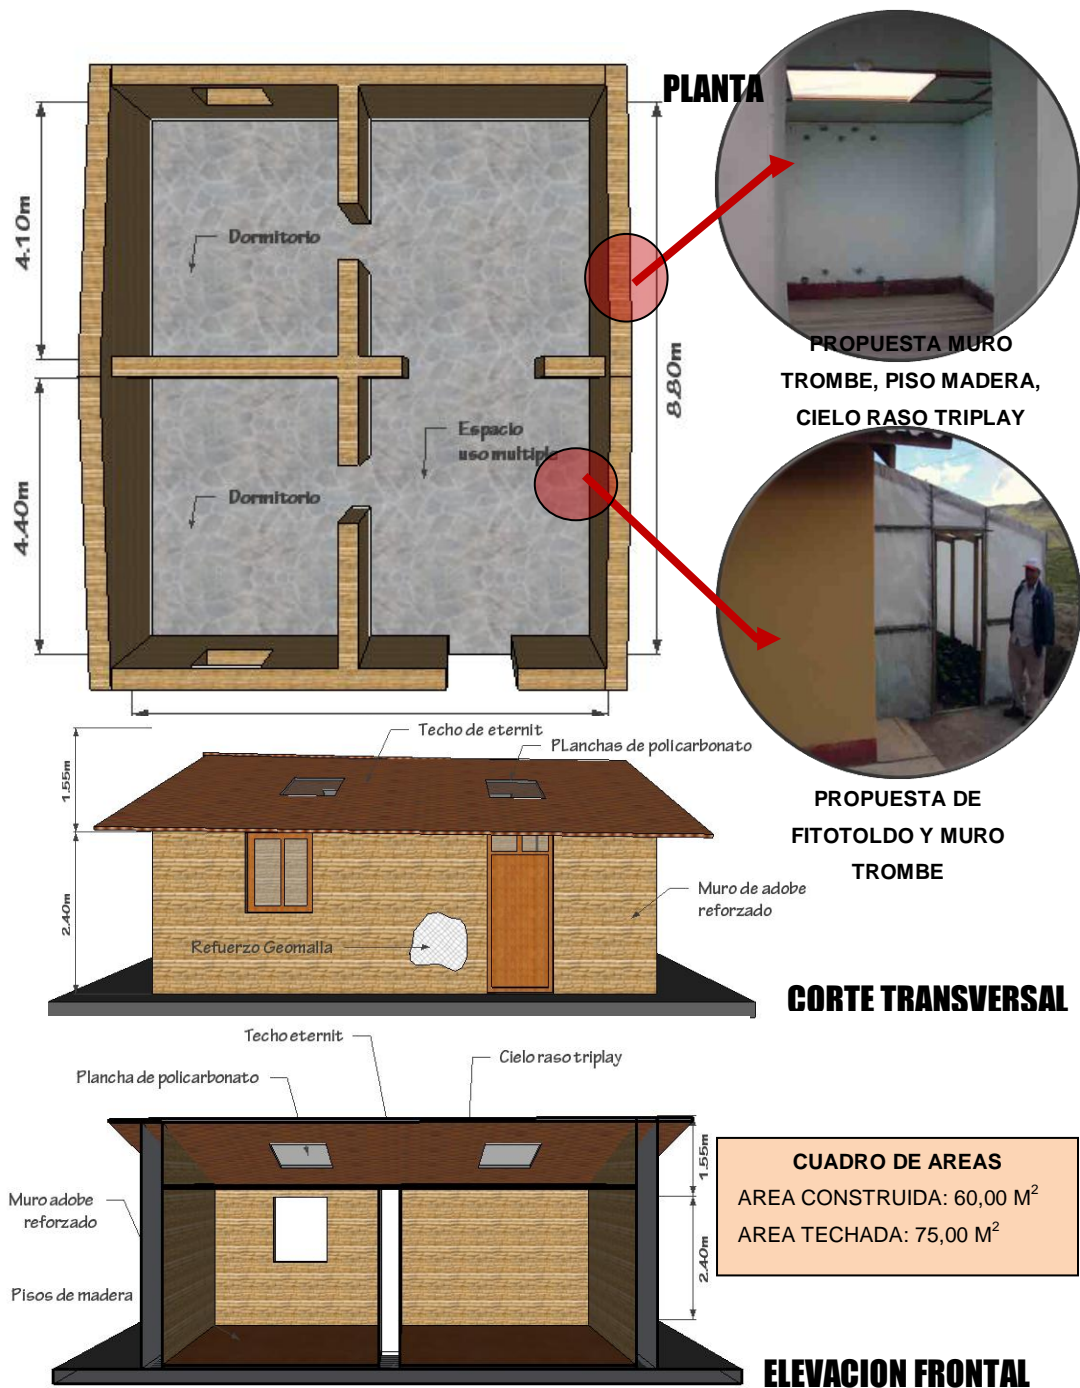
Propuesta de reforzamiento de vivienda rural con geomalla.
